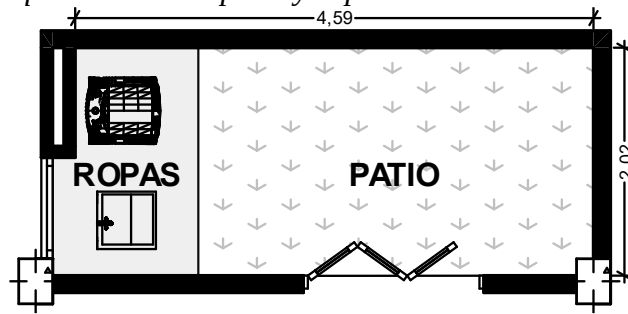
Propuesta arquitectónica área de proyección primera planta, primera fase
